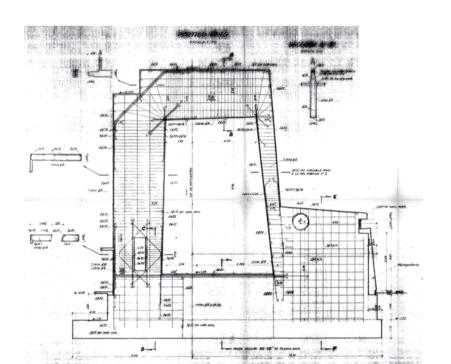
Pórtico 15 de Apoyo al Este se considera apoyo por no tener rigidez la lámina en el eje longitudinal.
